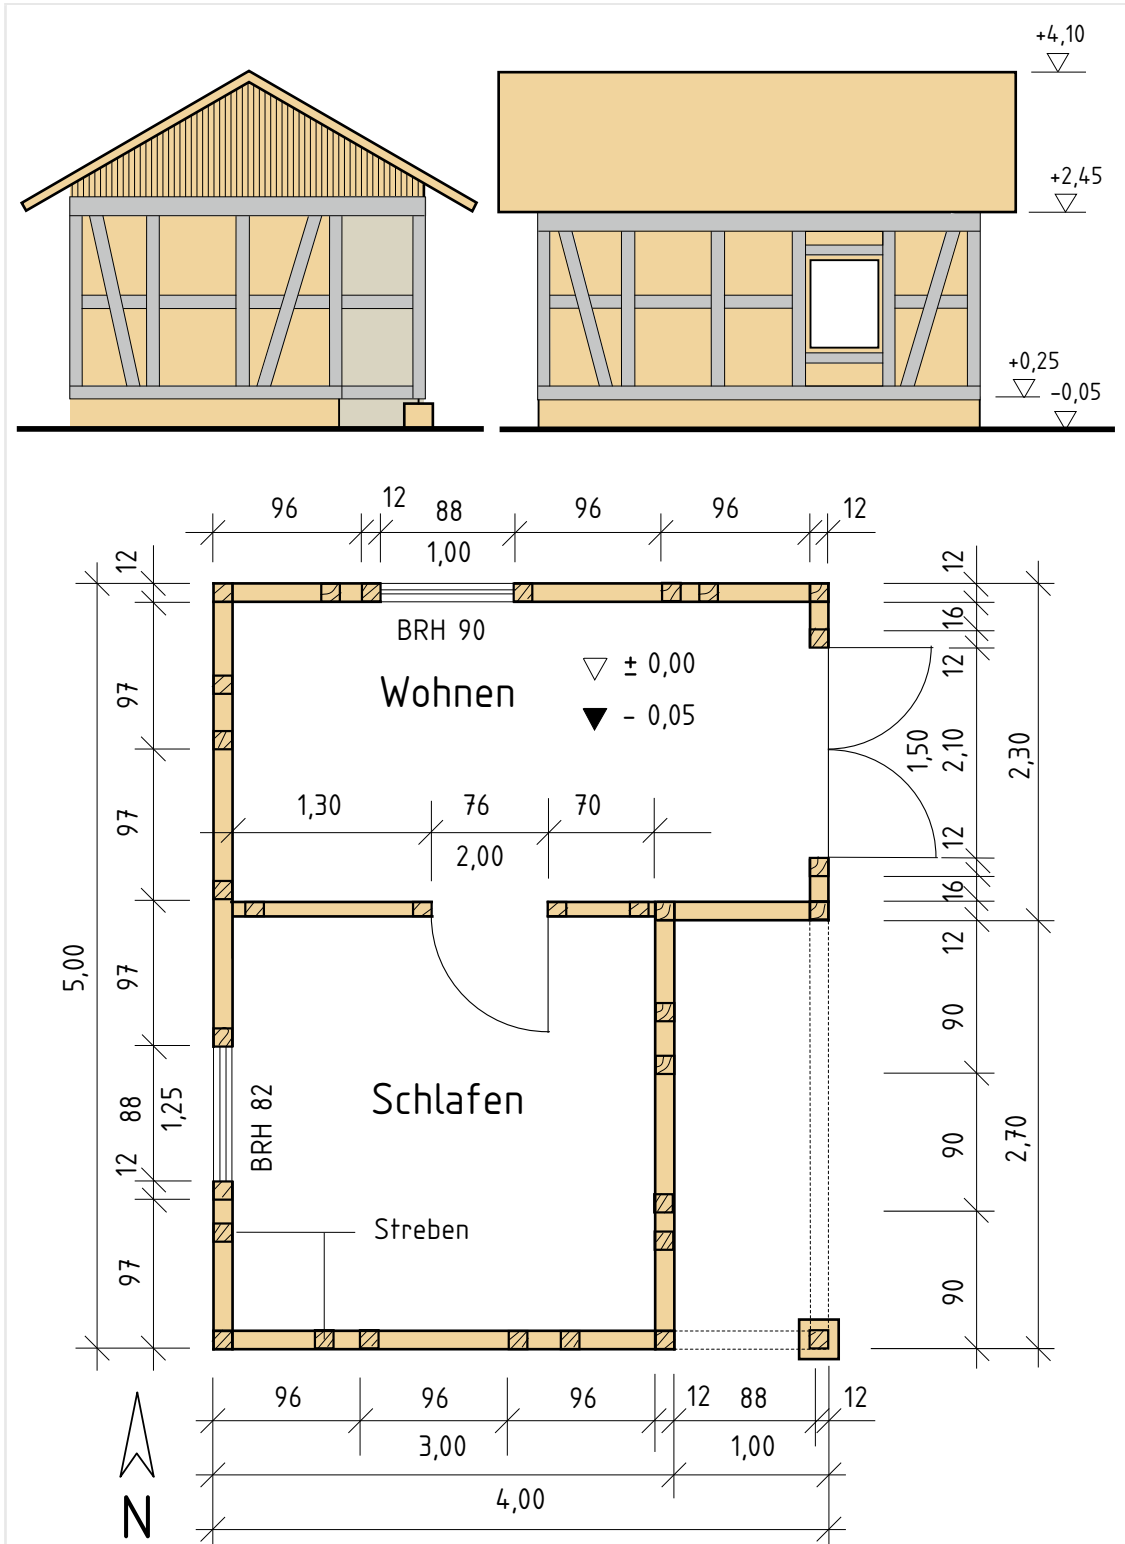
Ansichten und Grundriss des Tiny House
